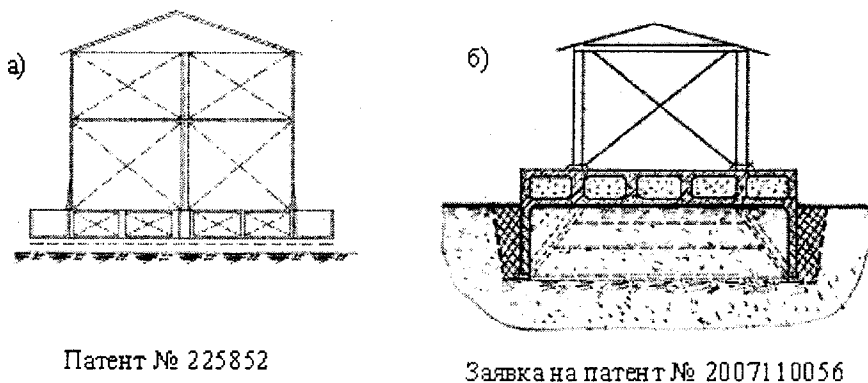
Примеры малоэтажных зданий замкнутого типа для строительства в сейсмических районах, в сложных грунтовых условиях, объединенных с пространственной фундаментной платформой: *а* – незаглубленное со скользящим слоем, *б* – конструкция «стена в грунте»
